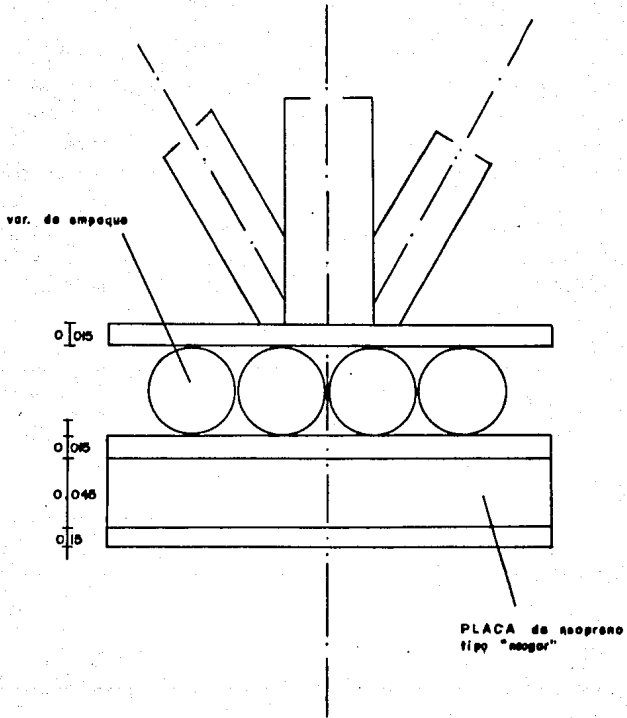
CORTE DEL APOYO DE LA ESTRUCTURA ESPACIAL
